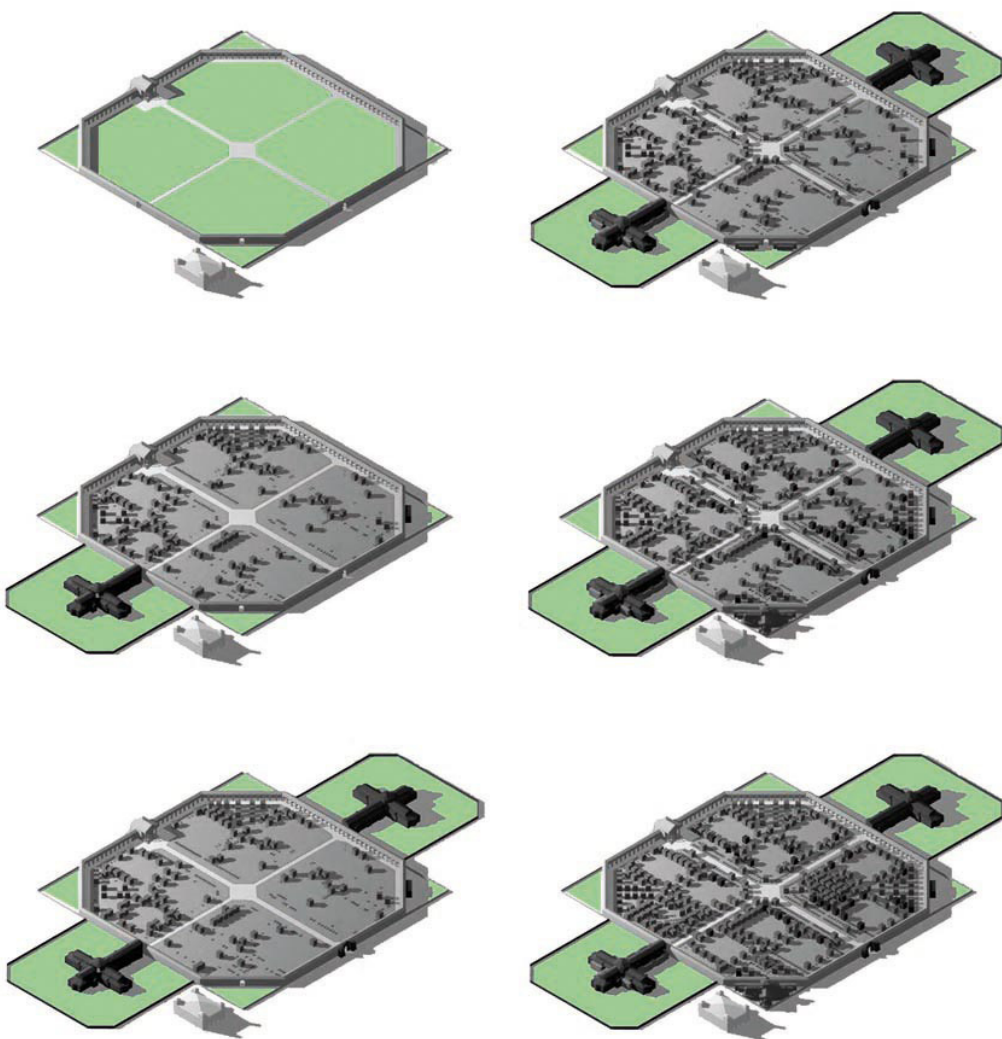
Cimitero della Villetta a Parma, planimetria (ottagono e ampliamenti storici).
